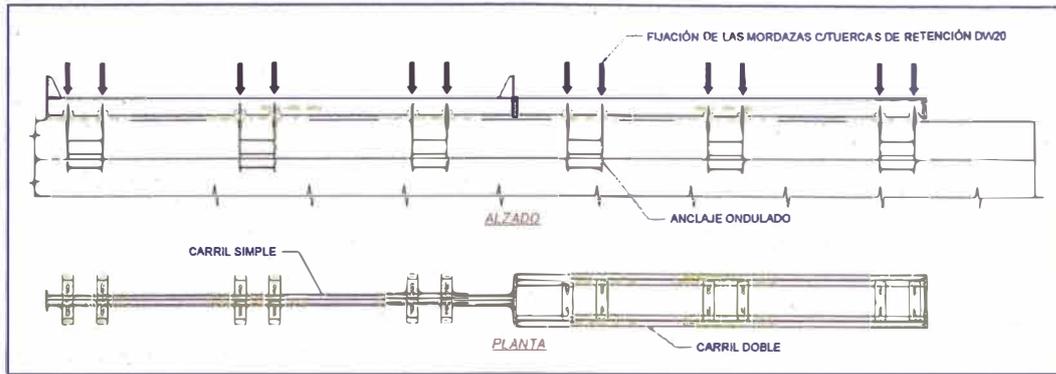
Vista elevación de colocación de anclajes de los carriles - Fuente: Elaboración Propia
